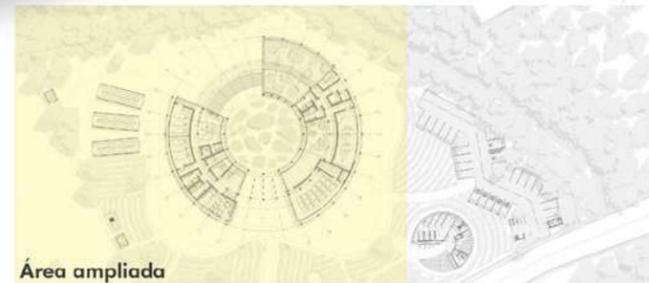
SMART E-Lab, planta arquitectónica del nivel 1
